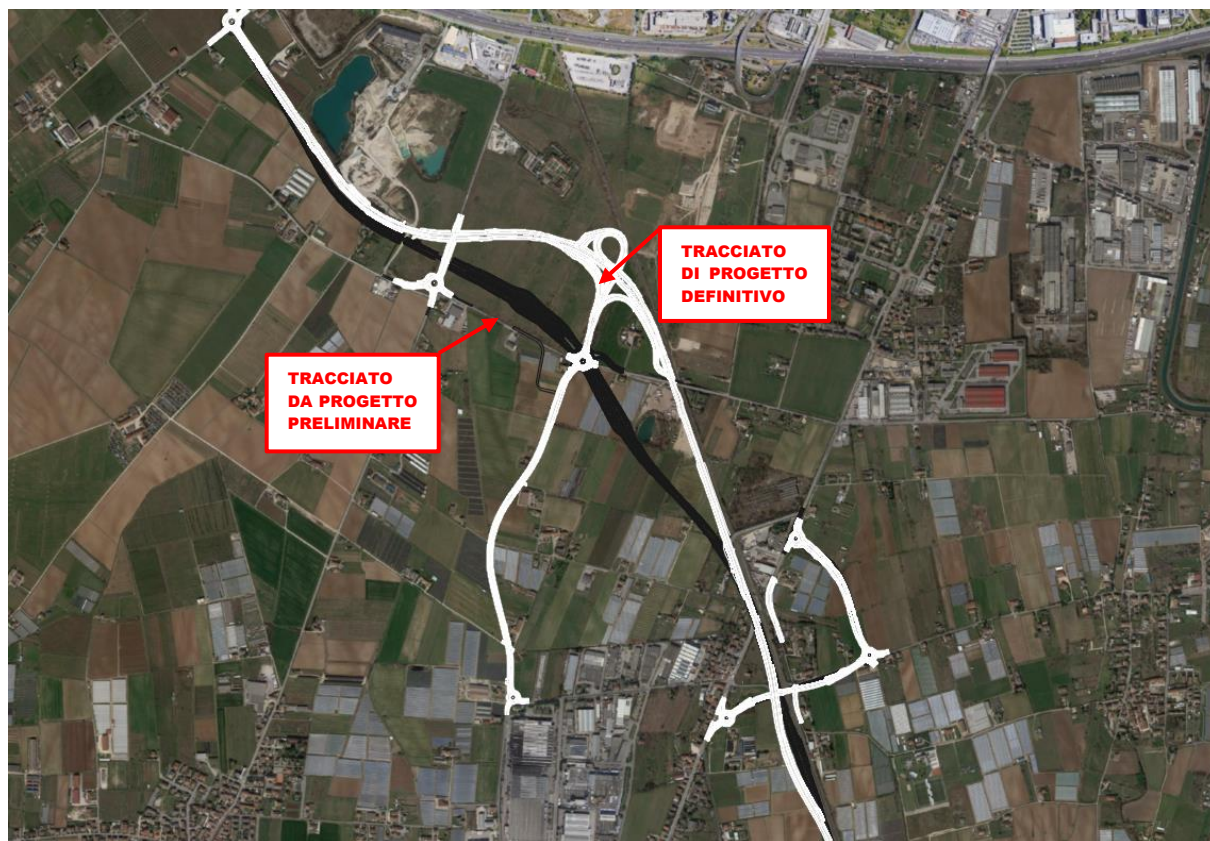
Stralcio planimetria di confronto progetto preliminare-progetto definitivo
